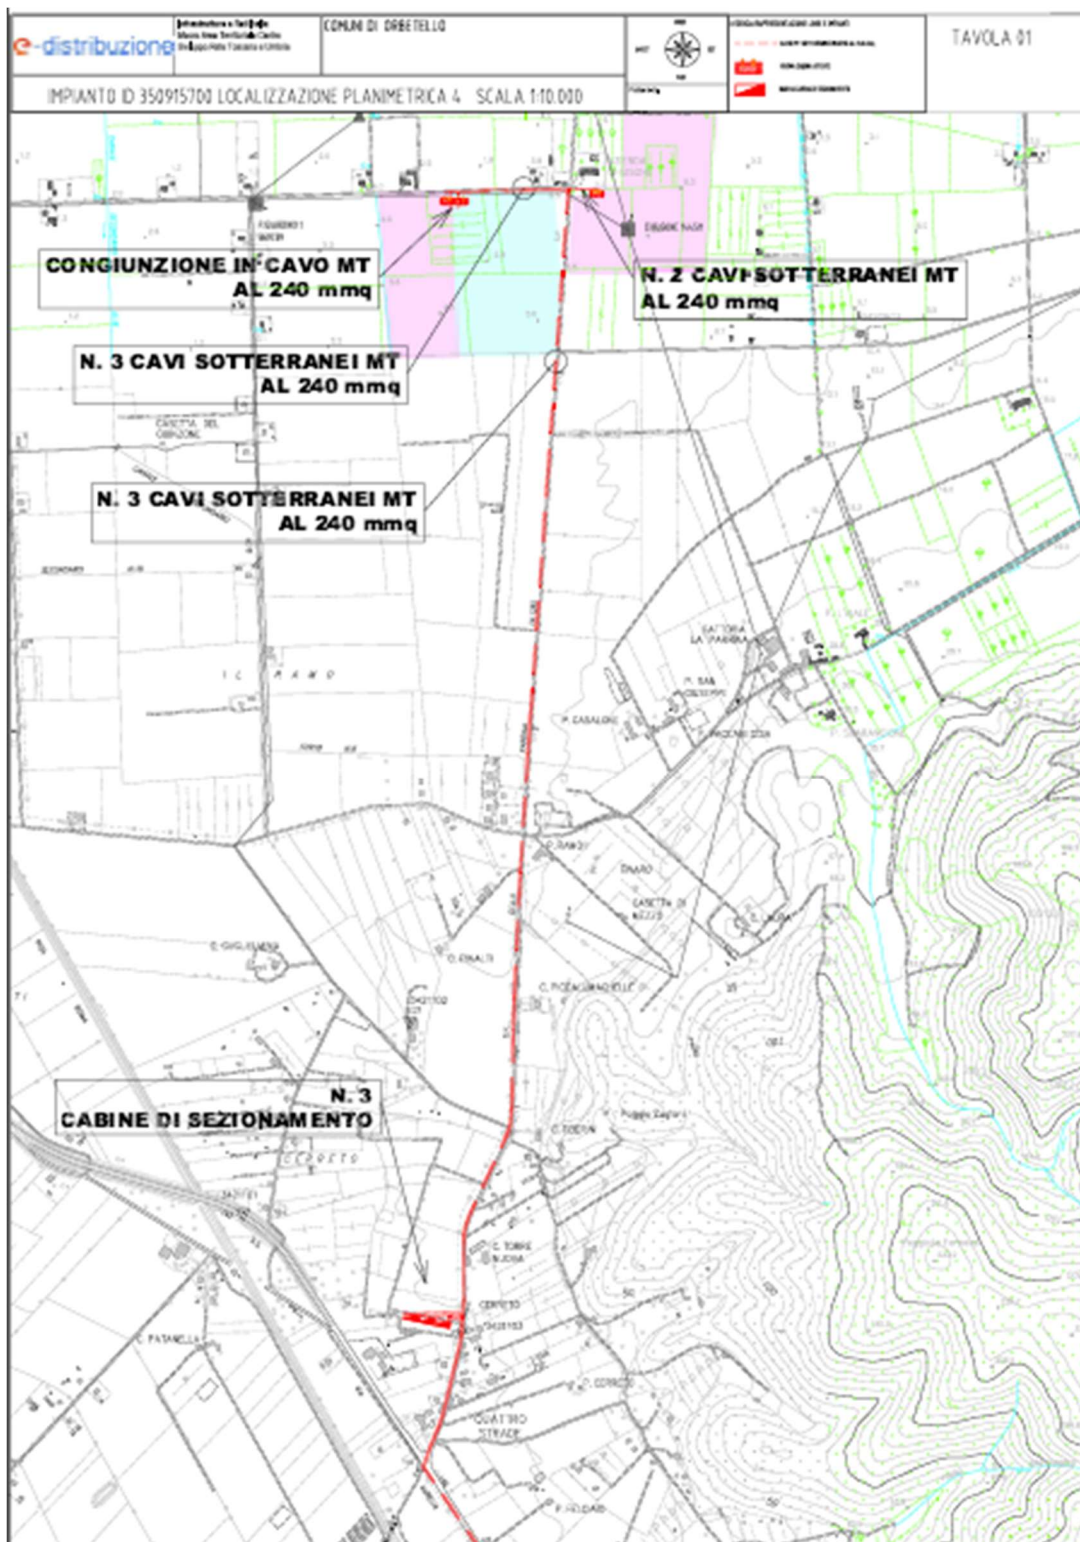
Impianto di rete per la connessione con cavo interrato – TAVOLA 01
